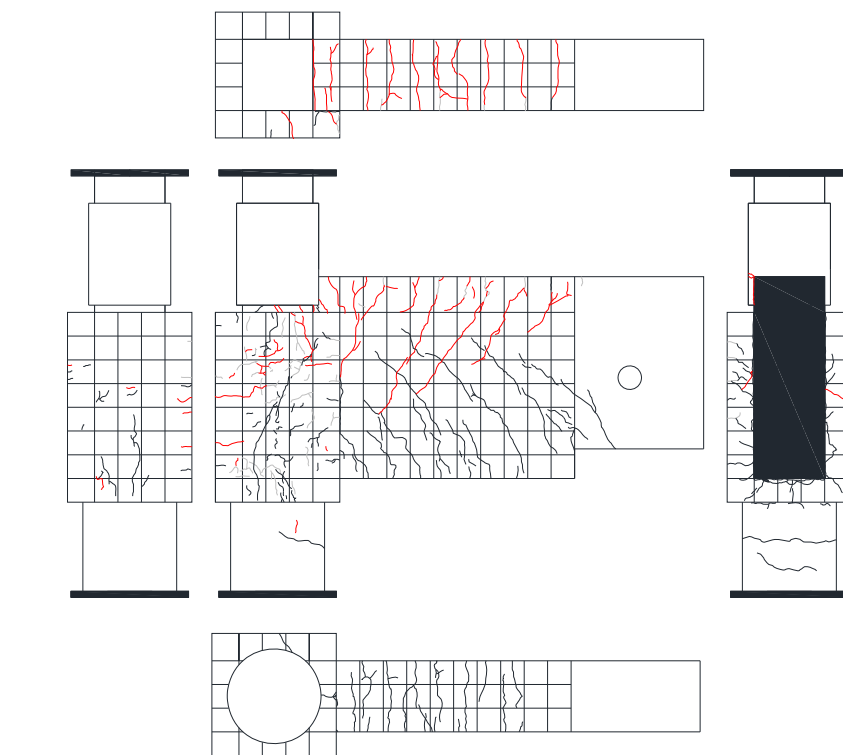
E-2 ひび割れ状況 (2Cycle)
